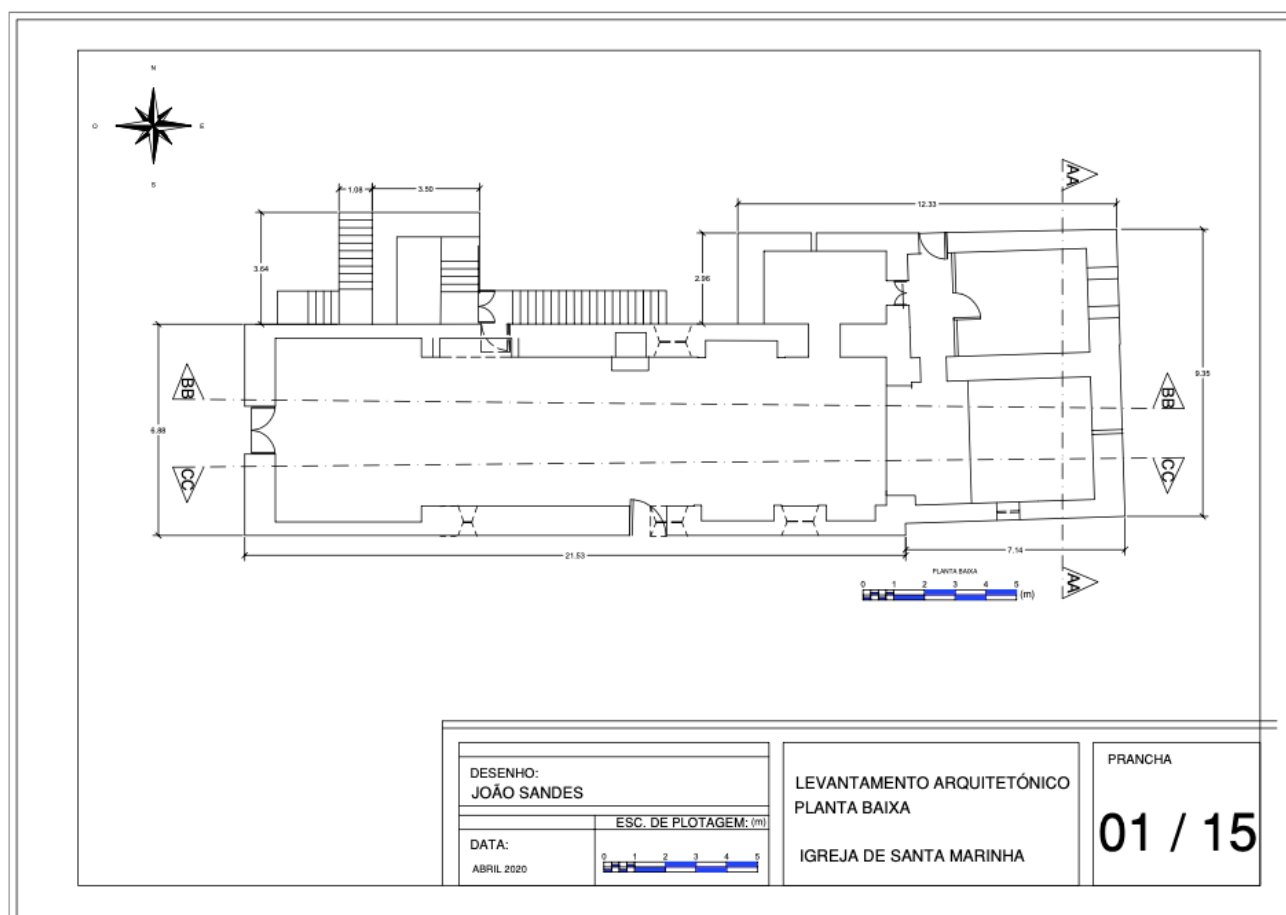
Planta baixa obtida com o levantamento arquitetónico tradicional.
